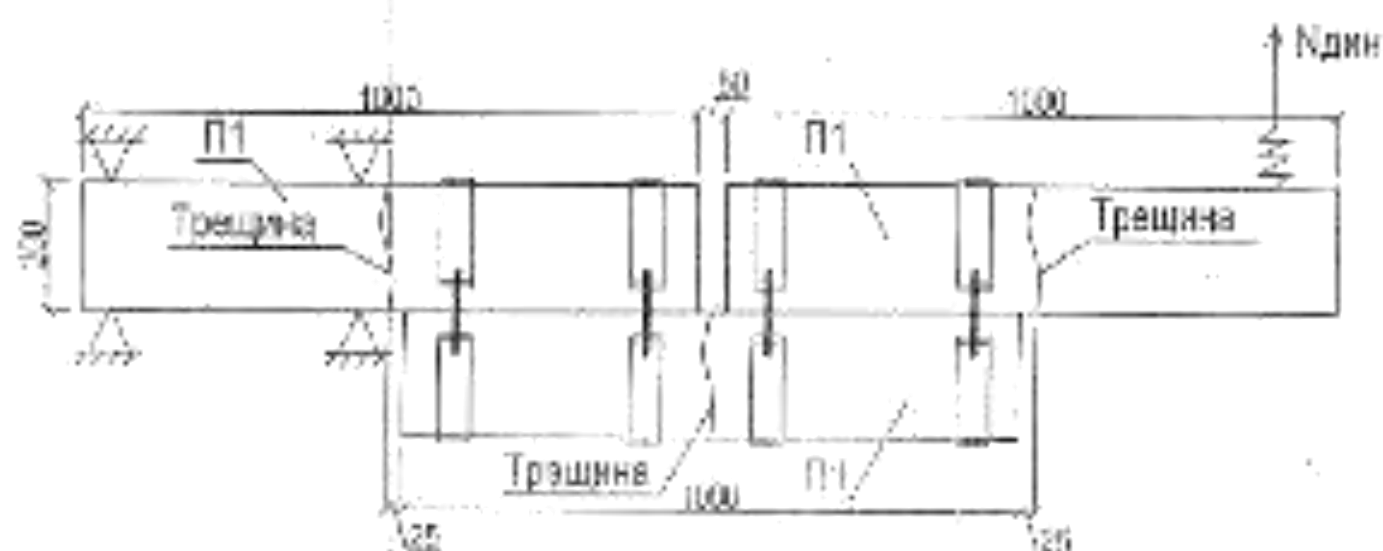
Схемы испытаний блоков со стеклопластиковой арматурой.
